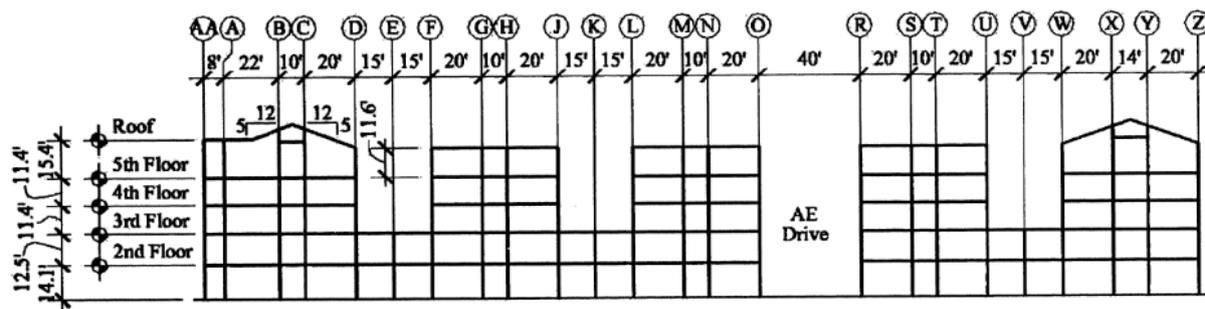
Поперечный разрез здания (для перевода футов в метры умножить на 0,3048)
